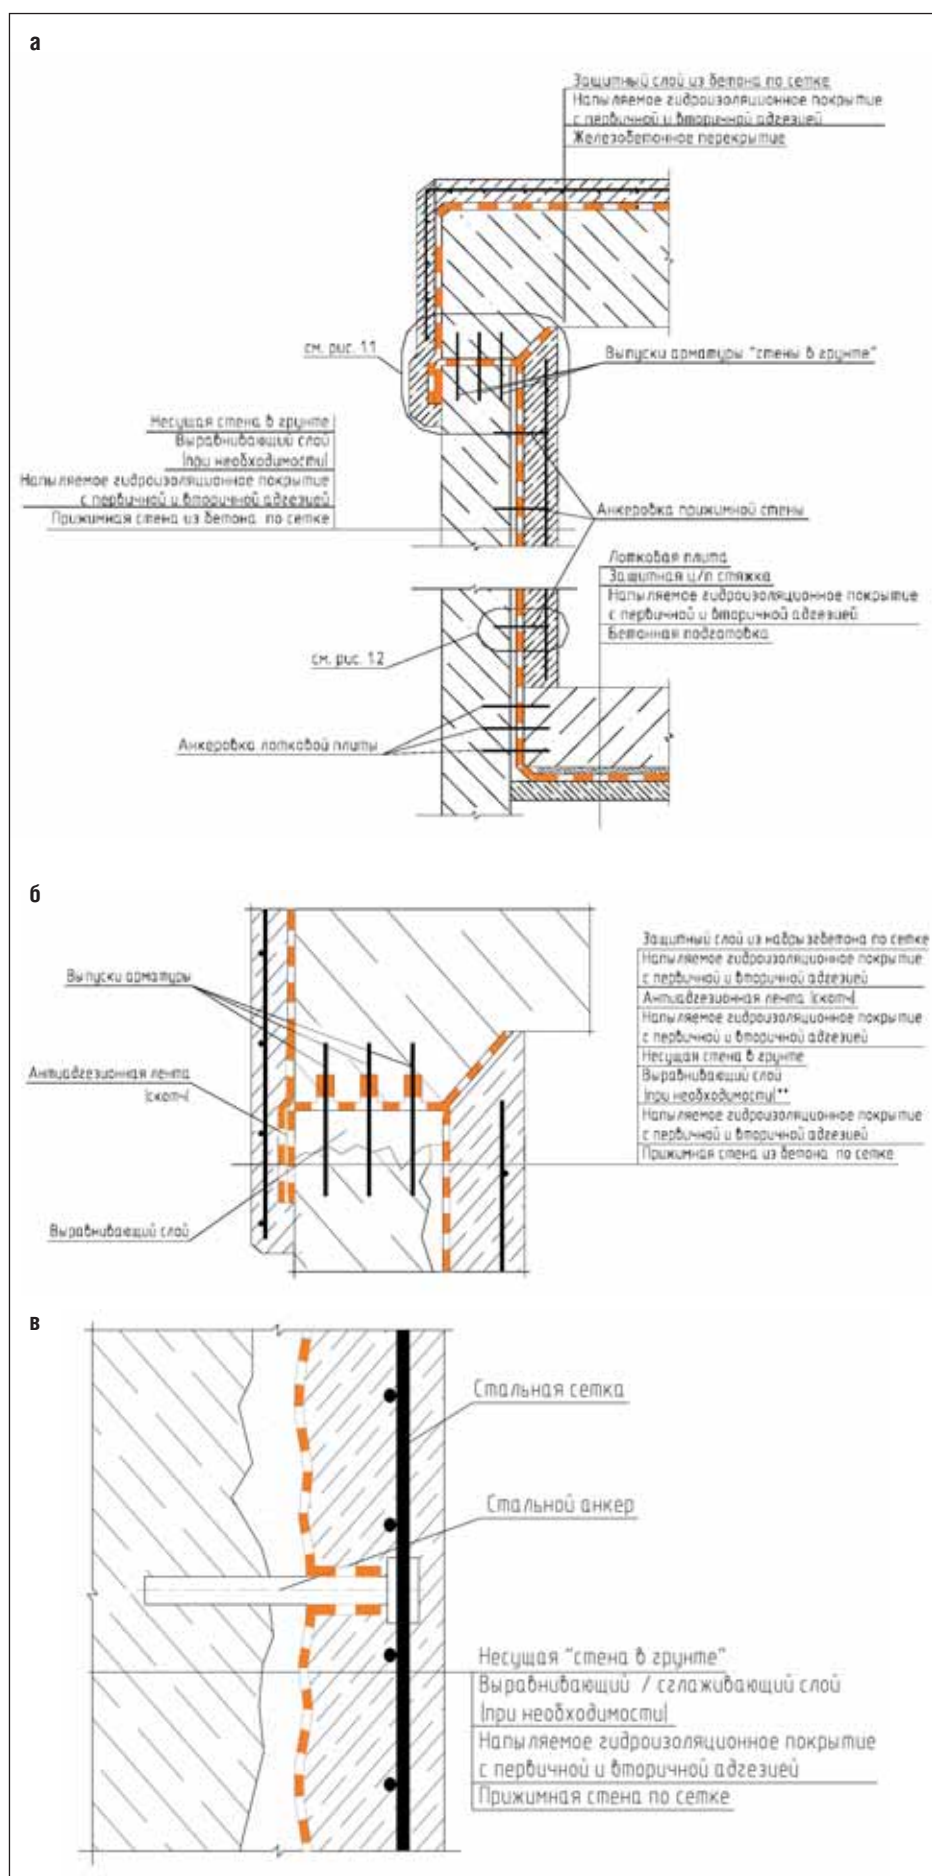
Устройство напыляемой гидроизоляции тоннельного сооружения при открытом способе работ с несущей «стеной в грунте»: а – общий вид; б – узел сопряжения «стены в грунте» с перекрытием; в – узел примыкания прижимной стены к «стене в грунте»
